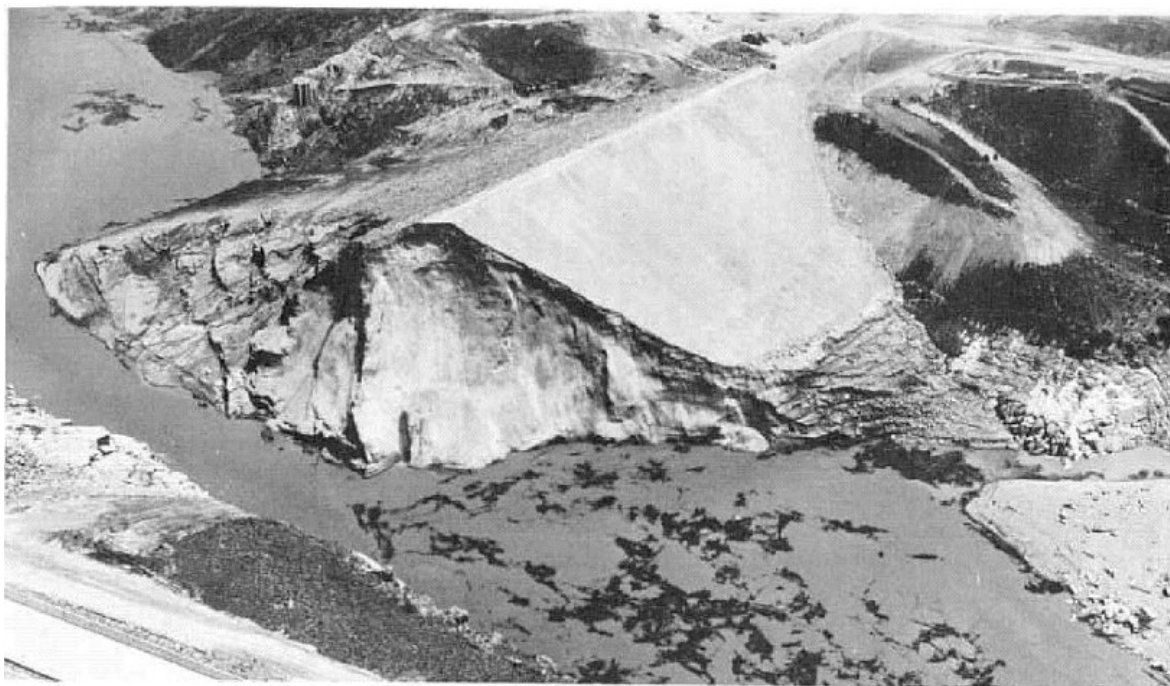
Barragem de Teton, nos Estados Unidos. Vista de jusante ap s a falha da barragem (Fonte: JANSEN, 1983).
